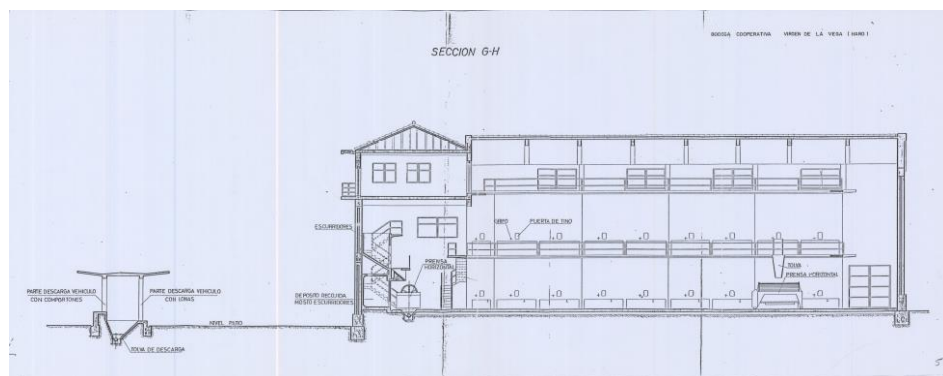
Sección longitudinal de la bodega Interlocal Virgen de la Vega de Haro (La Rioja).
